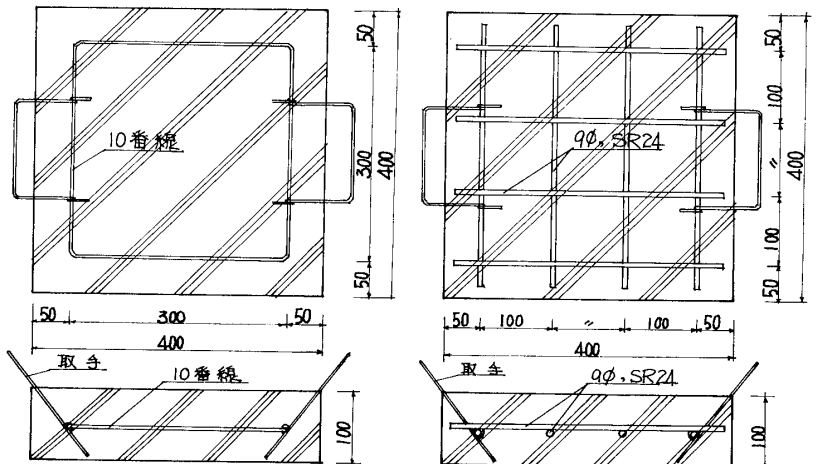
無筋コンクリート版 (単位: mm) 図-2 有筋コンクリート版 (単位: mm)
